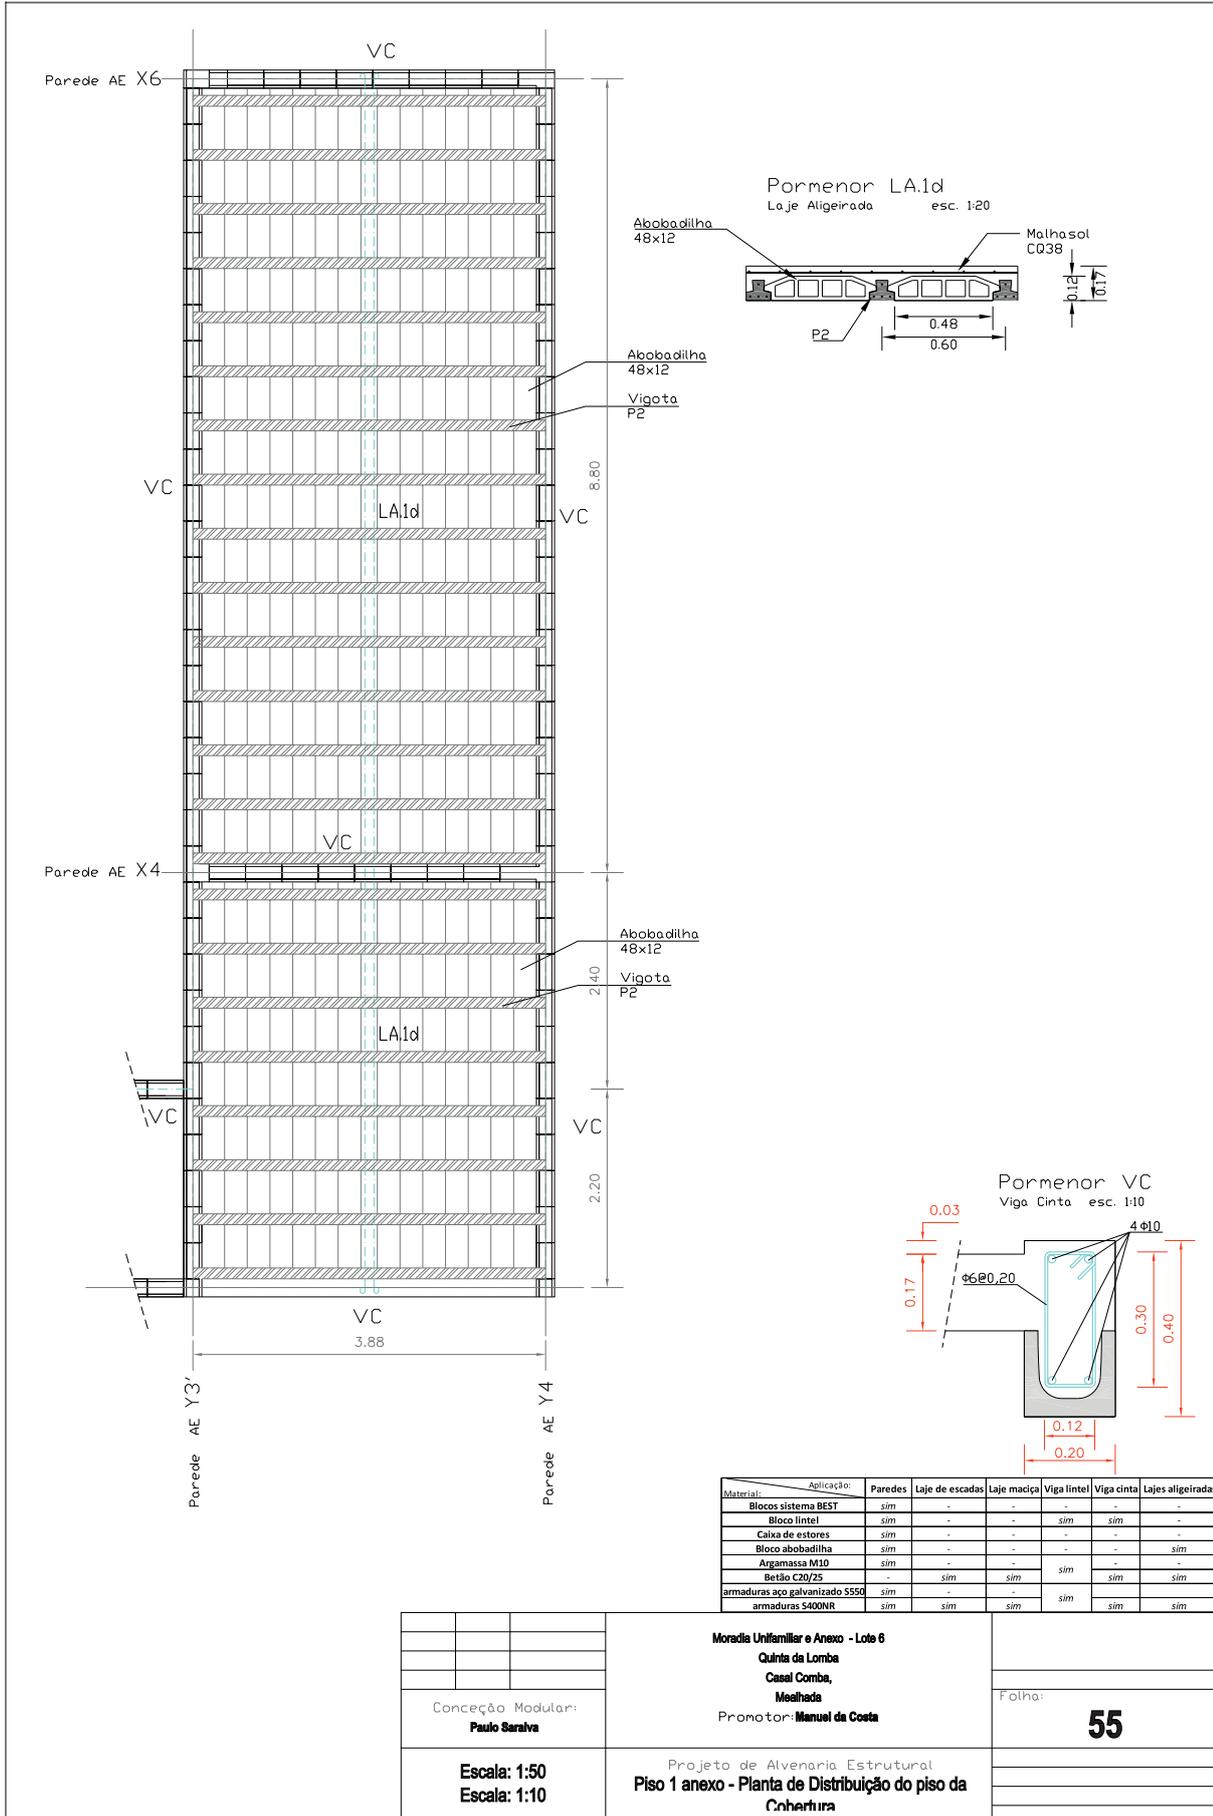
Planta da laje da cobertura do anexo da solução em AE
